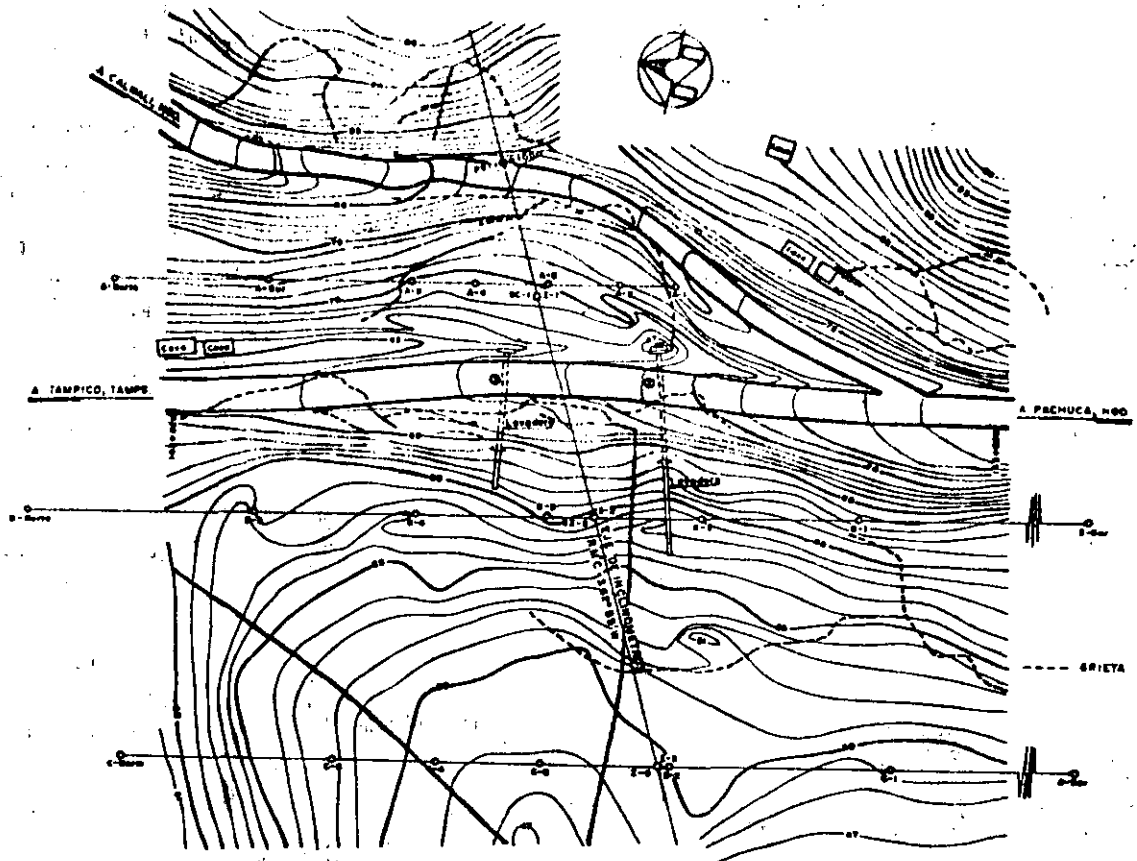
Planta topográfica de la zona de deslizamiento.
